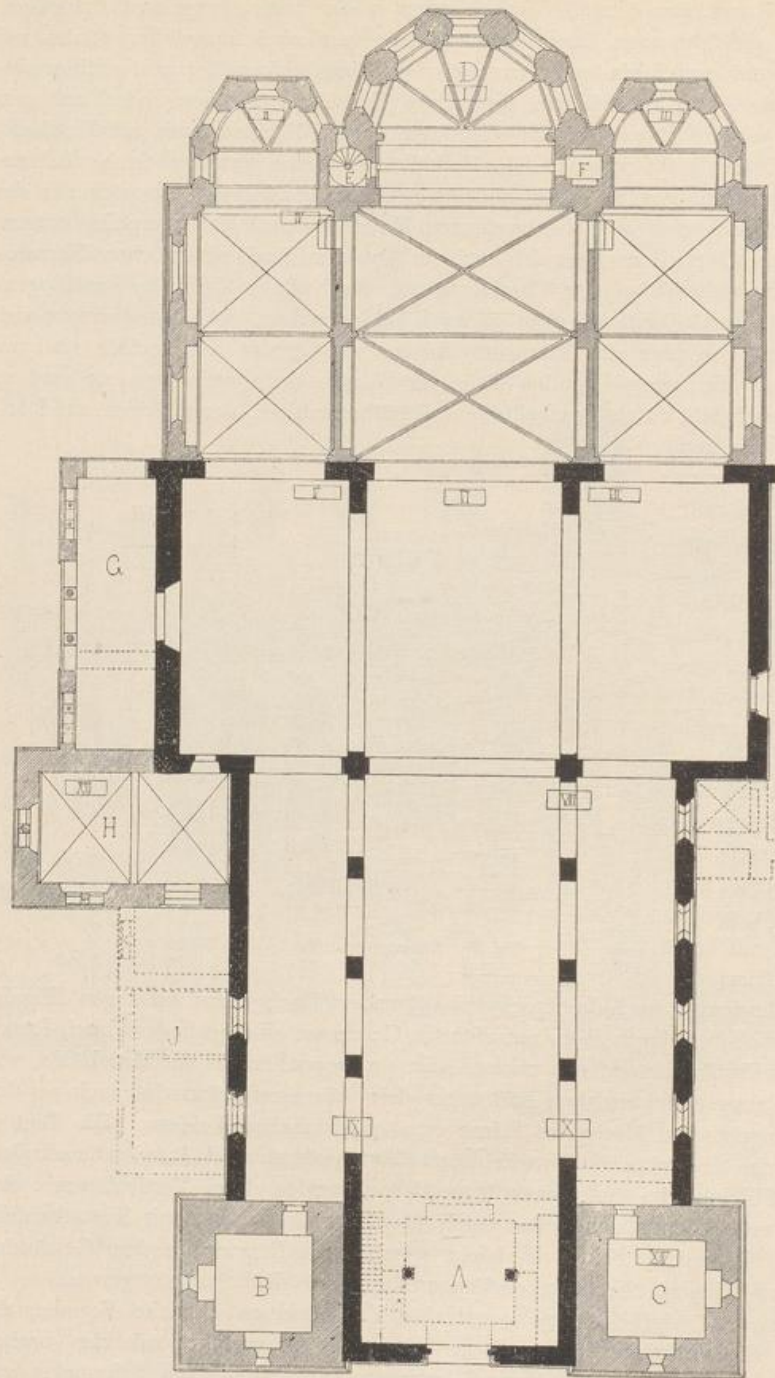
Kaiserswerth. Grundriss der Stiftskirche.
